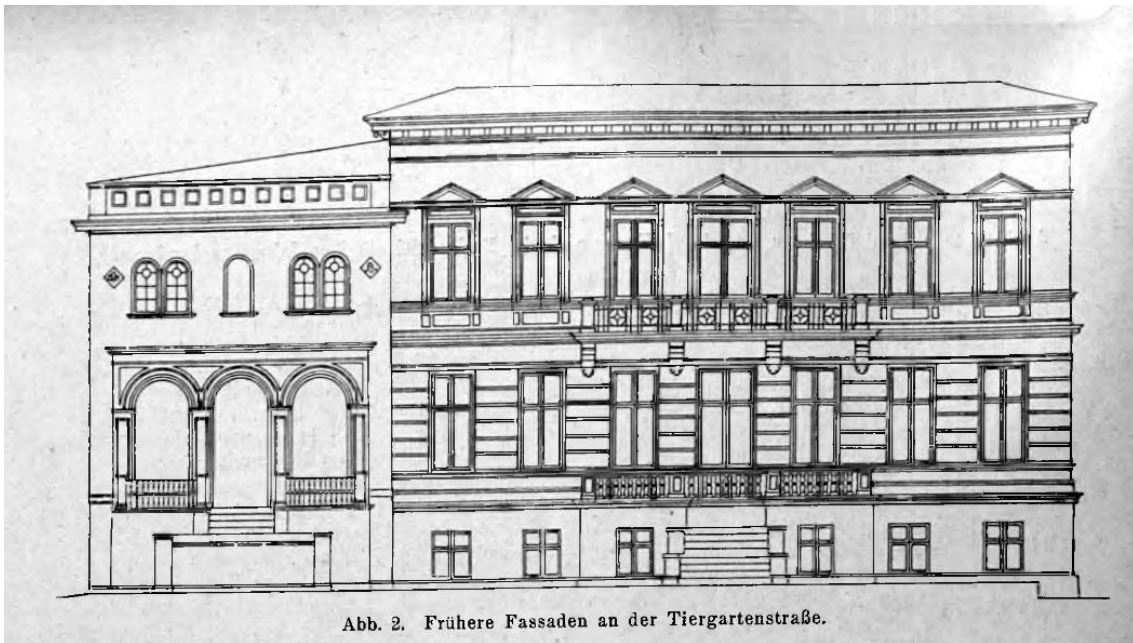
Frühere Fassaden an der Tiergartenstraße.
